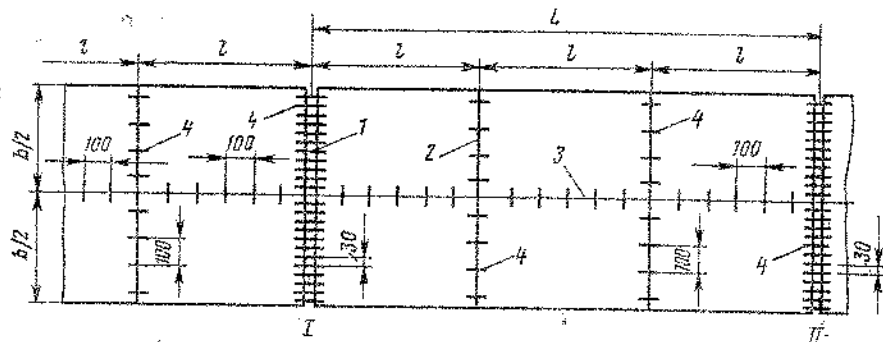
Схема расположения швов цементобетонного покрытия:
